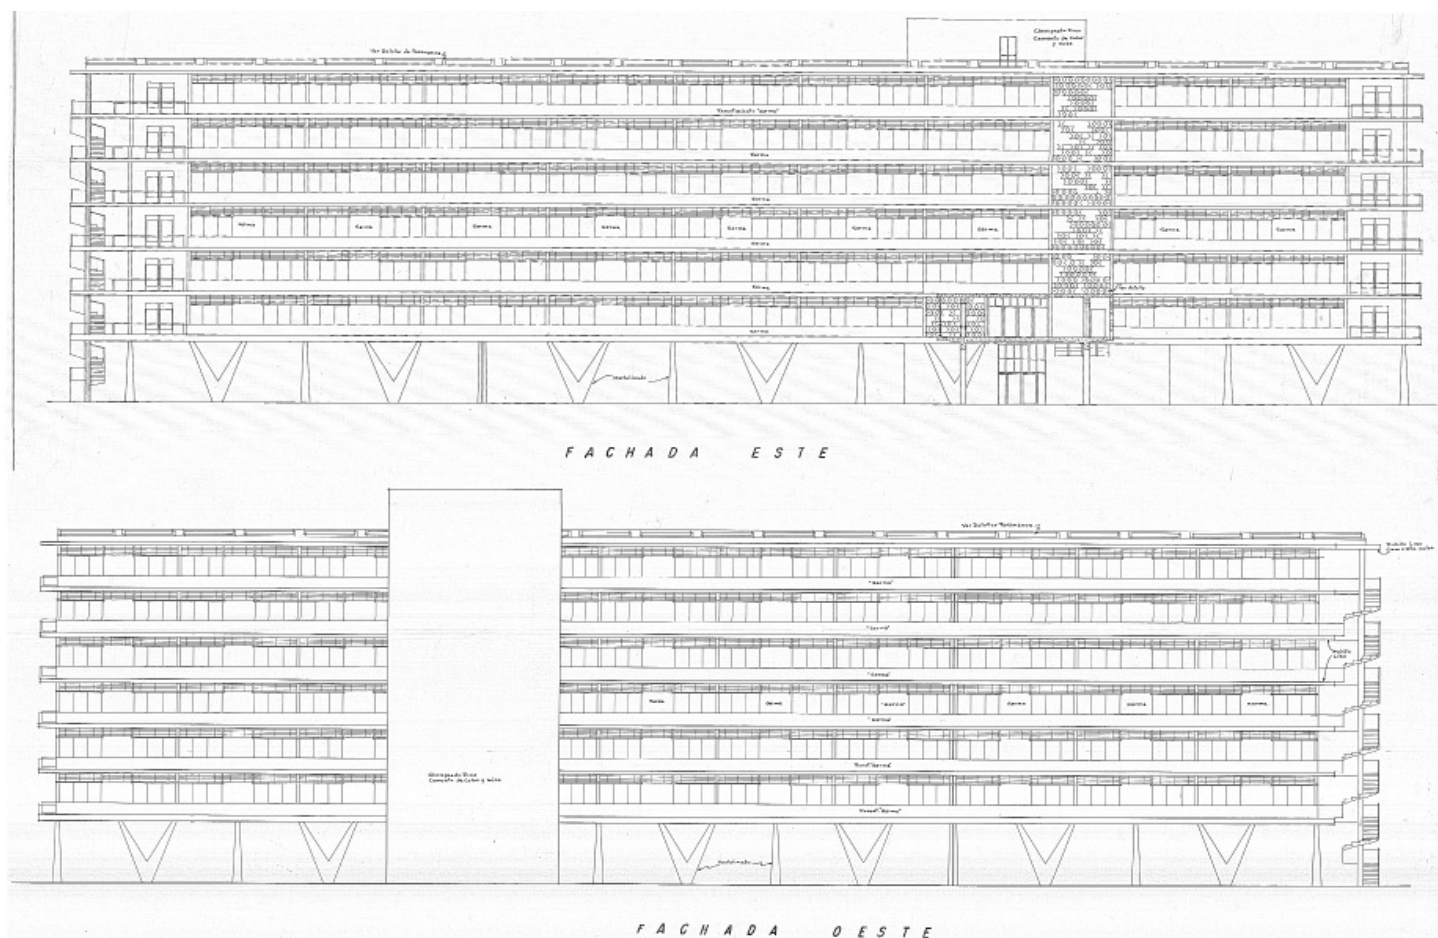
Planos arquitectónicos de fachadas originales de la Residencia Estudiantil (septiembre de 1958).
